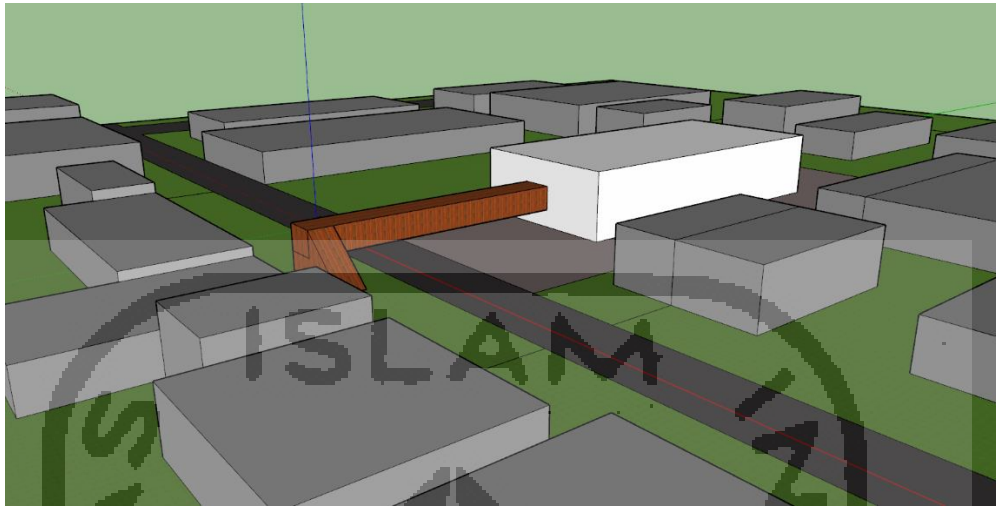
Tiga Fasilitas Publik diArea Site
